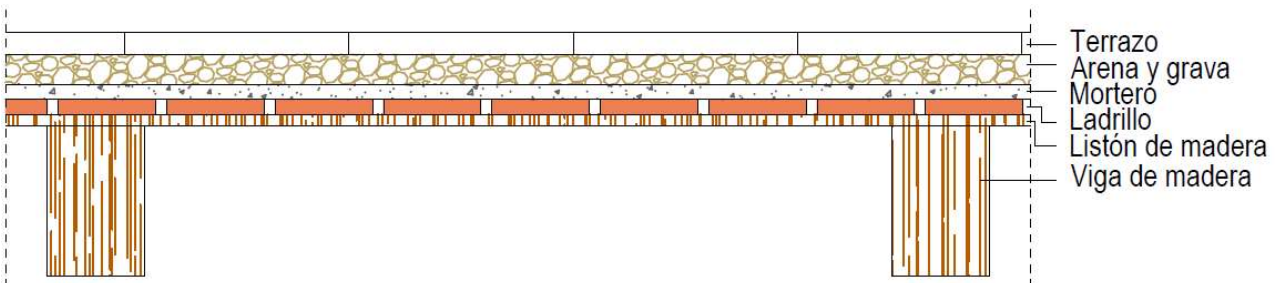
Forjado de viguetas de madera con entrevigado de ladrillo cerámico sobre listones de madera.
